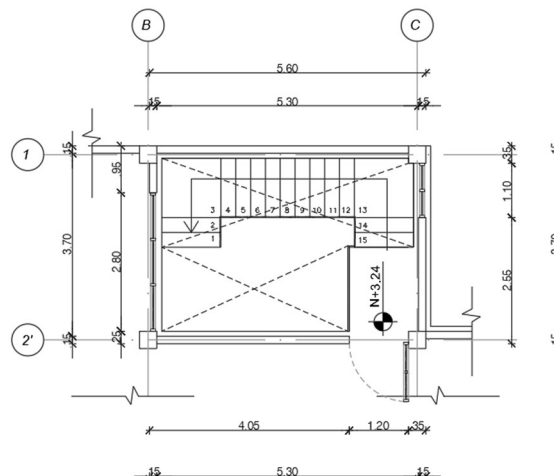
Planta 2 arquitectónica del caso de estudio.
